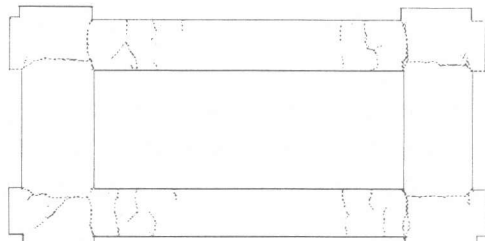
OPEN FRAME のひび割れ状況 ( $R = 2\%$ )
